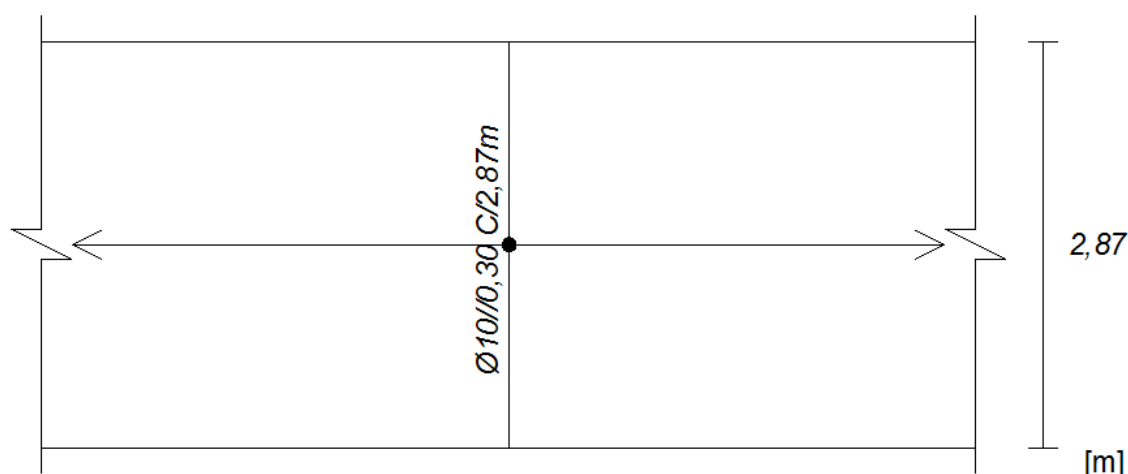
Pormenorização das armaduras de pré-esforço transversal da laje em planta (Marques, J. 2013)
